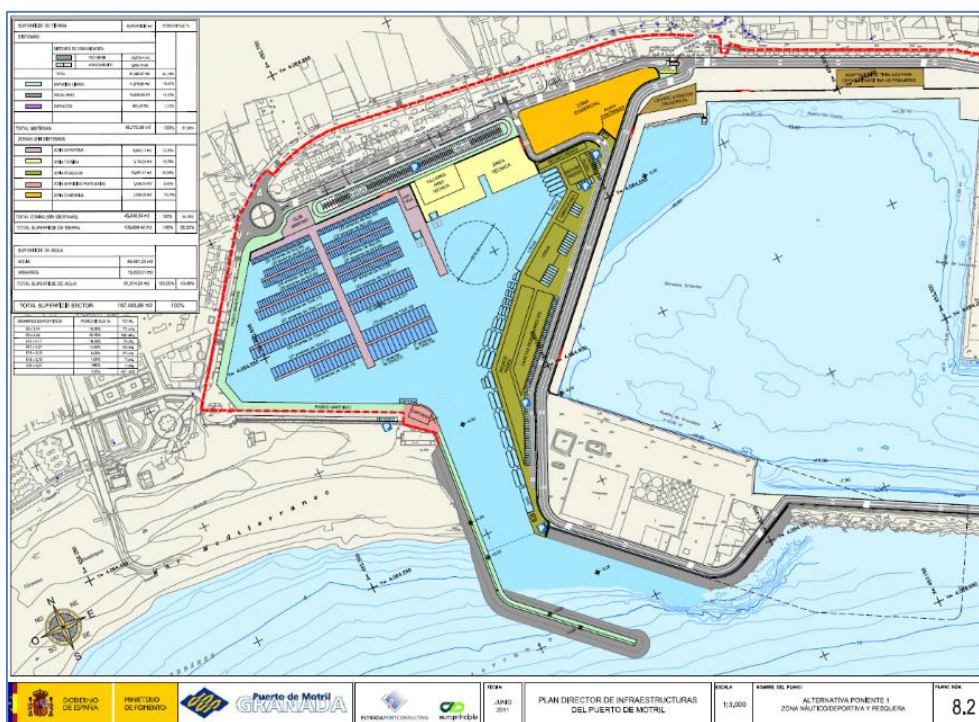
Planta de la Alternativa Poniente 1
